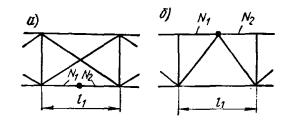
Схемы для определения расчетной длины элемента с различными усилиями N_1 и N_2 по его длине a— схема связей между фермами (вид сверху); b— схема фермы
